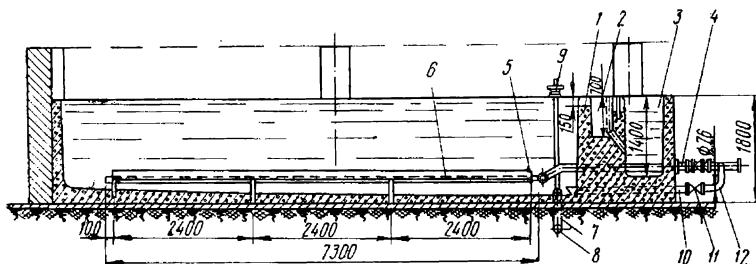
Чан для приготовления тузлука конструкции А. С. Большакова и др.
